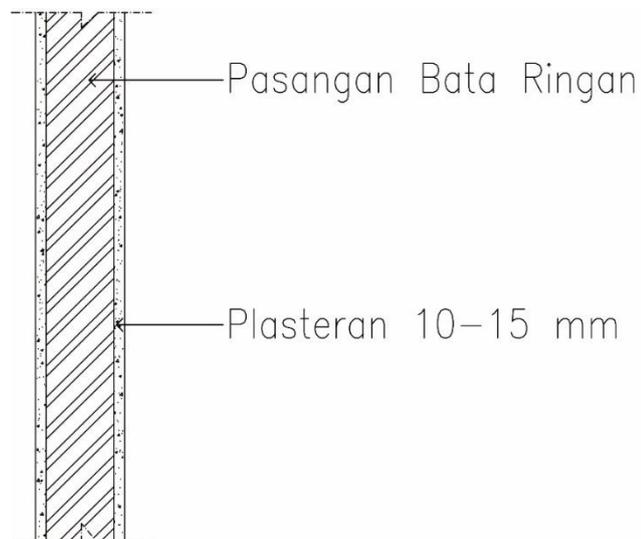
Denah rencana *finishing* dinding lantai 3
